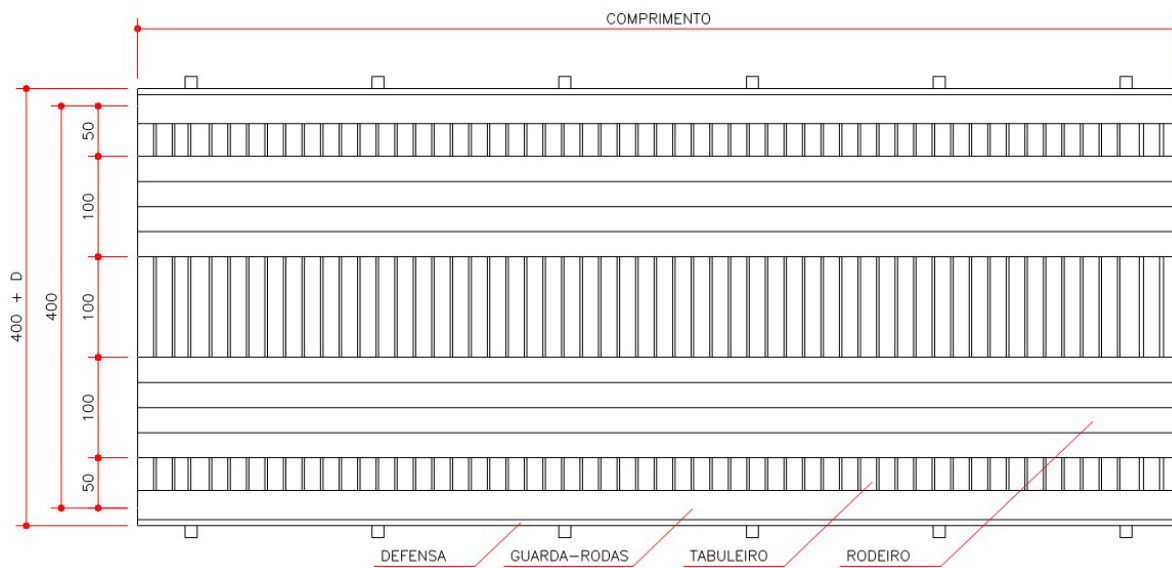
Ponte em vigas roliças de madeira tratada: vista superior da ponte. Fonte: CALIL et al (2006).
